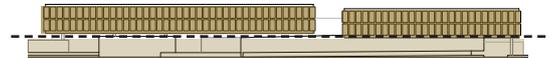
Esquema de la línea de unión -oscuro- entre la primera planta y la planta baja. Elaboración propia.
